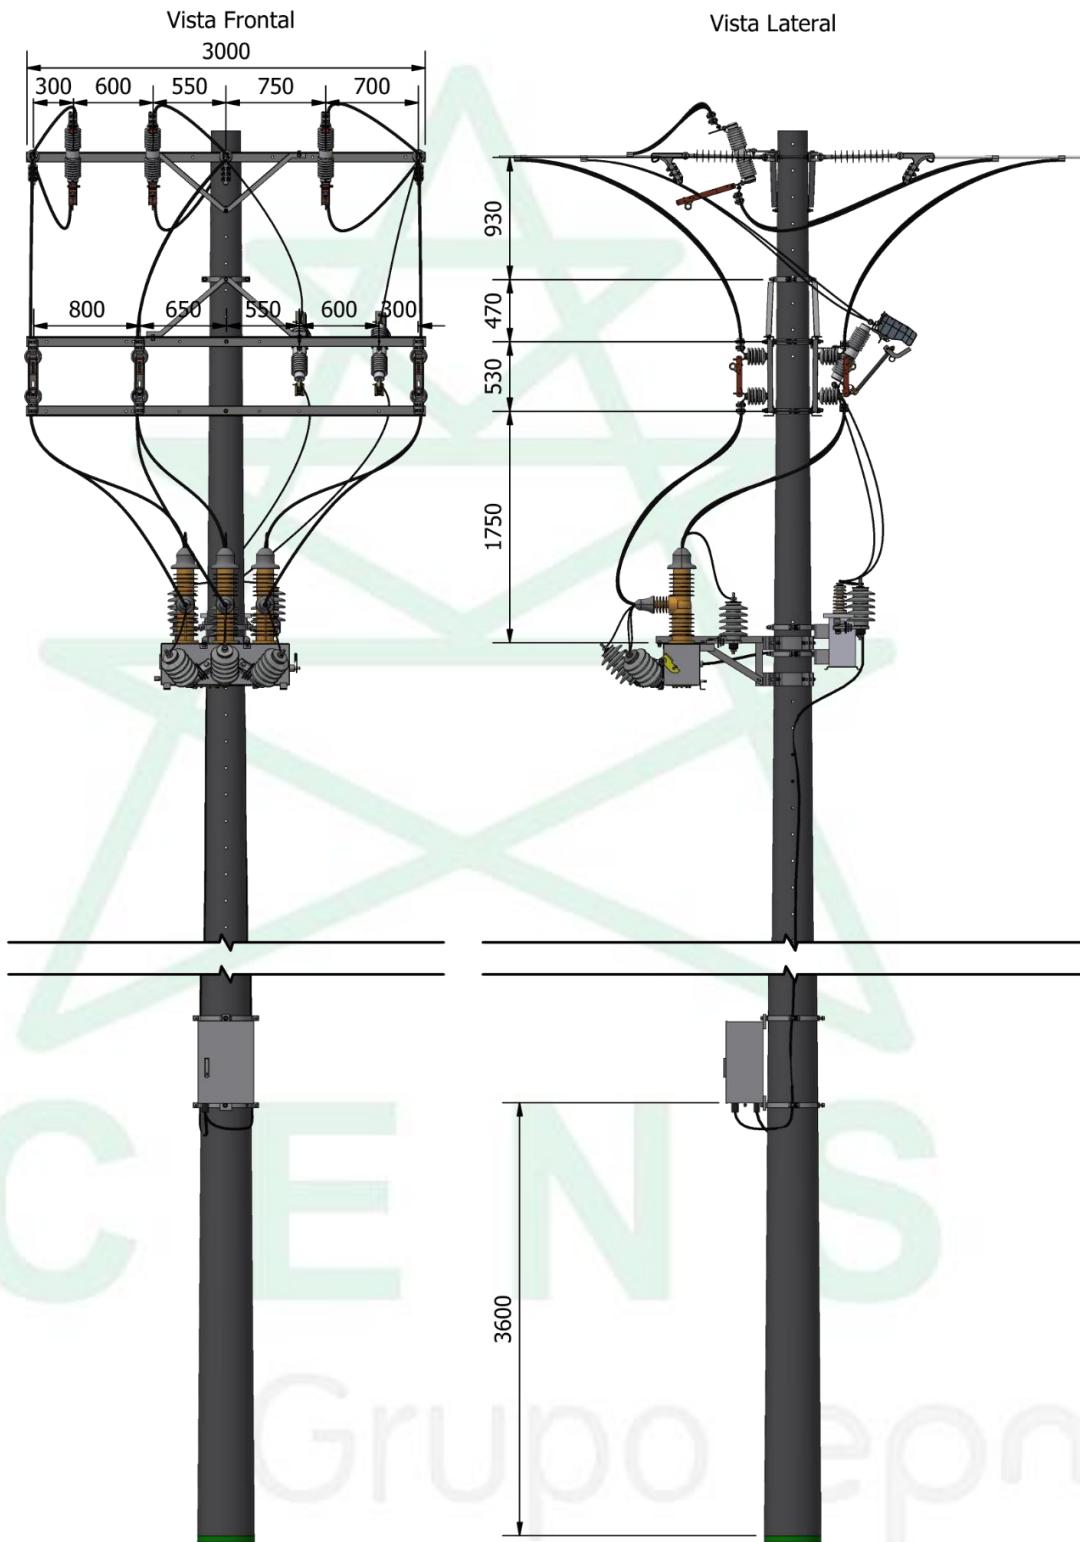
Dimensiones de montaje reconnectador 34.5 kV horizontal
